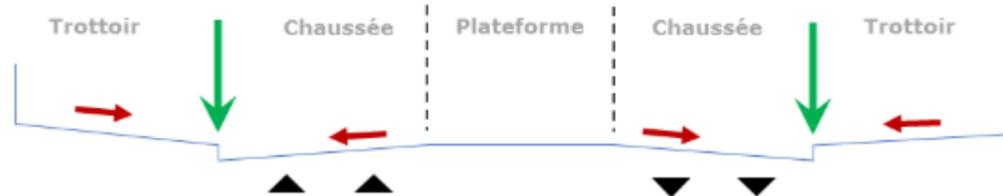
Profil en travers type sur la RN7 (source : PRO)
